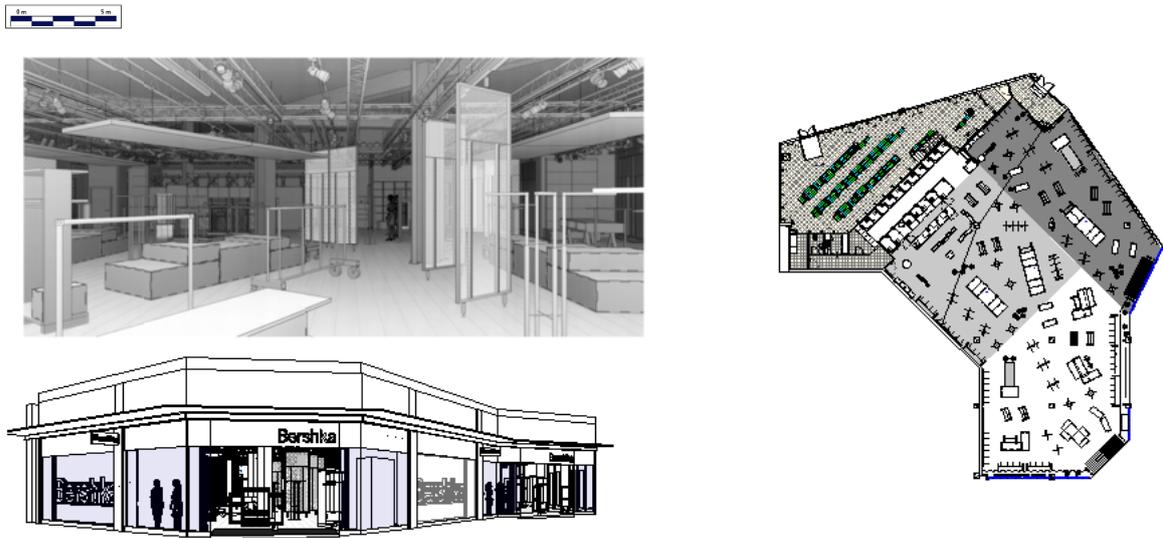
Perspectiva planta y fachada. (fuente: propia).
